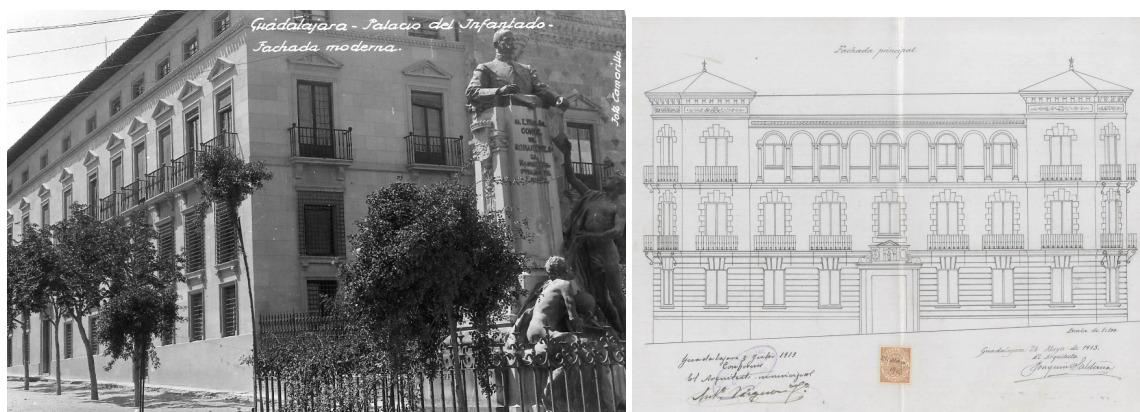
Fachada lateral del Palacio del Infantado. Proyecto: Cap. Senén Maldonado. Foto: Camarillo
